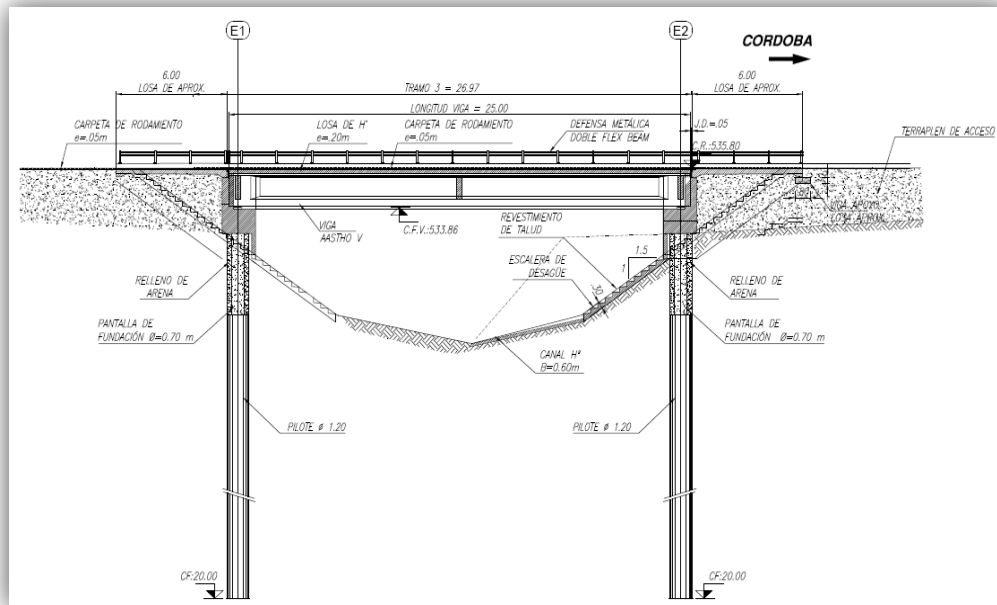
Sección longitudinal del puente. Pilotes de fundación
